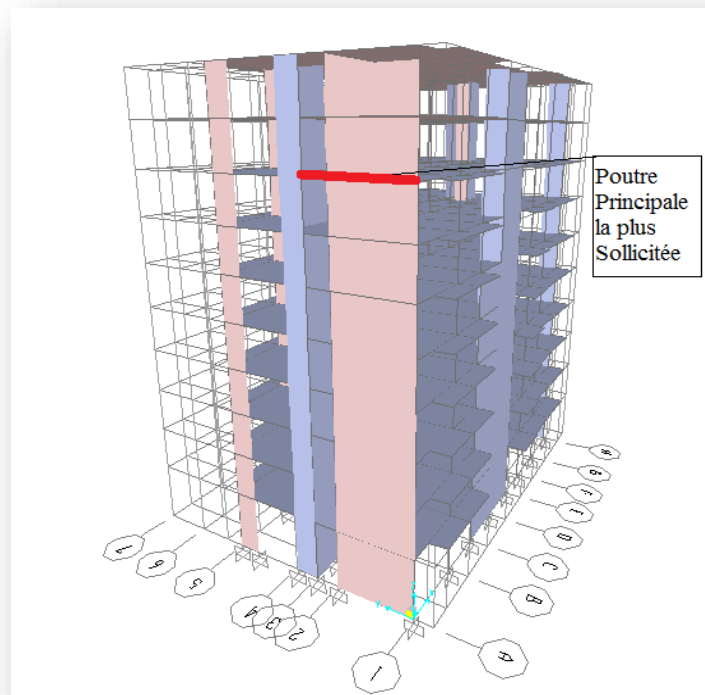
L'emplacement des poutres principales et secondaires.
